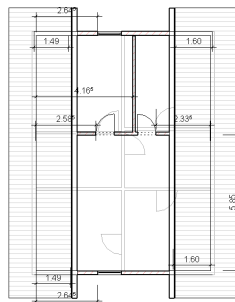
Grundriss des Dachgeschosses des Wohnhauses in Lemgo in Autodesk Revit (Quelle: KIT/IIP)
